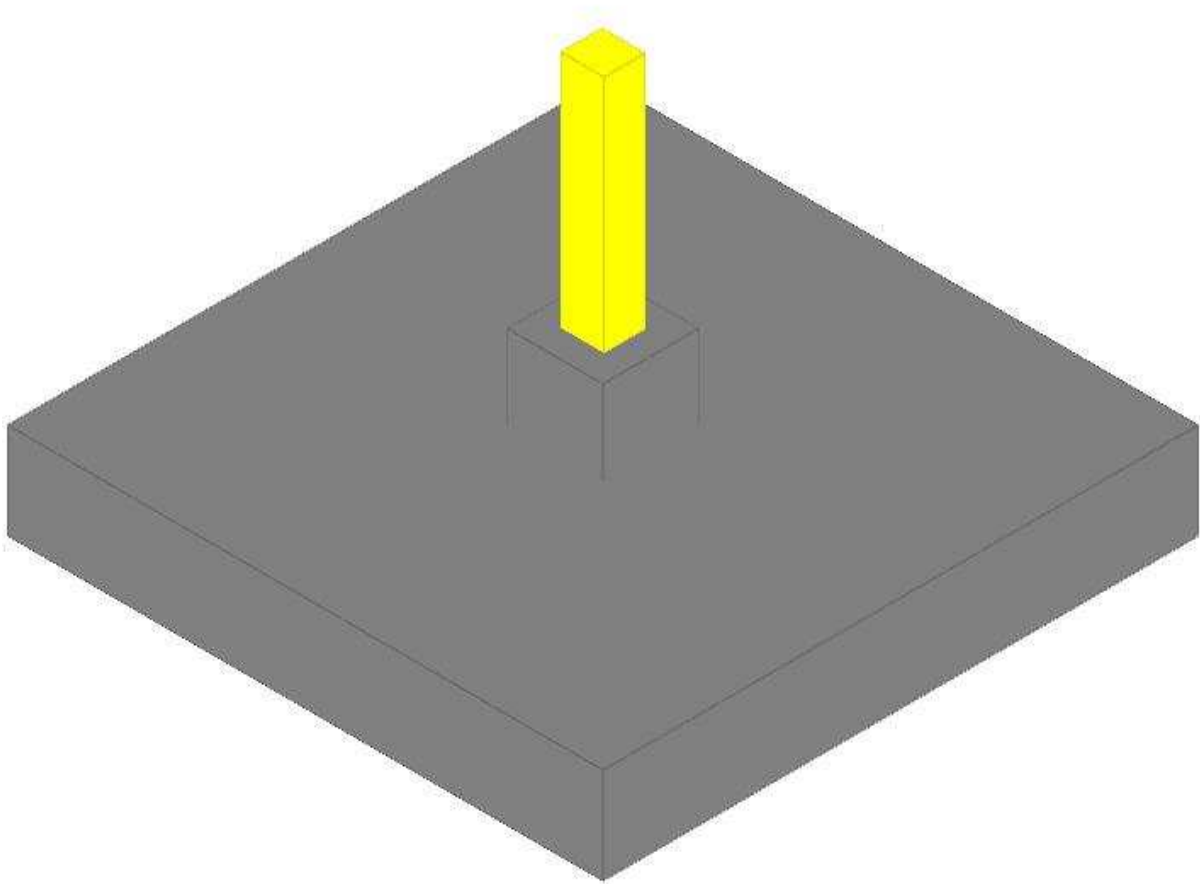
Particolare piastra di ancoraggio colonne HEA con trave in c.a.
